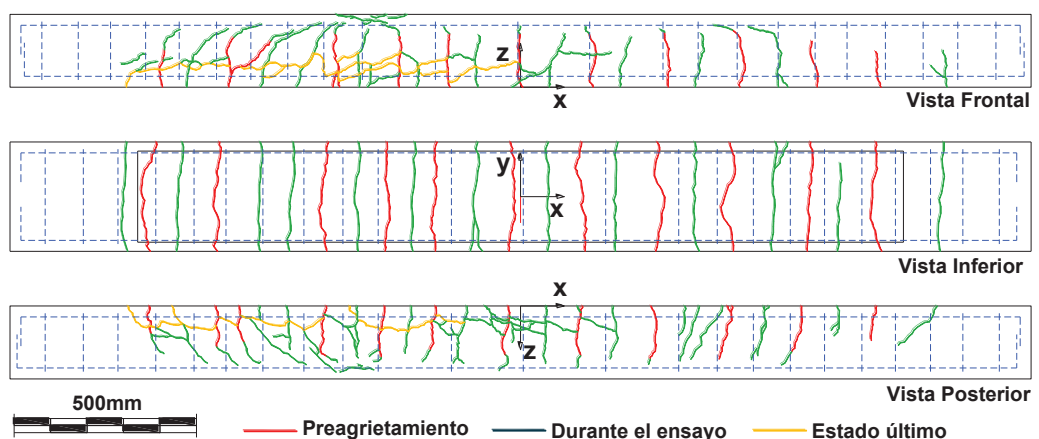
Esquema del patrón de agrietamiento de viga 1B durante el ensayo por carga última.
